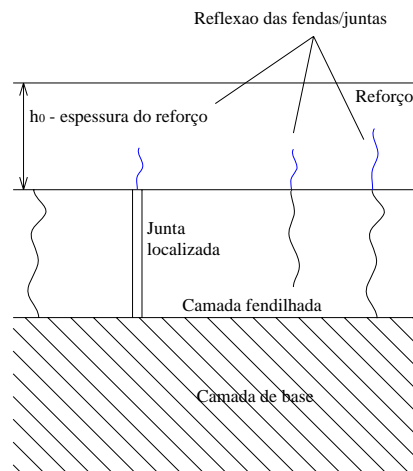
Corte de um pavimento fendilhado com um reforço de pavimento
